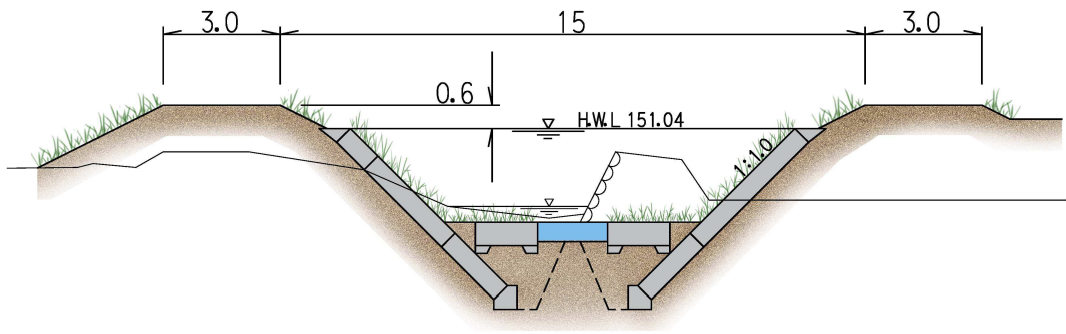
松尾川代表断面図 (国道 13 号橋から上流 0.1km、単位 : m)
